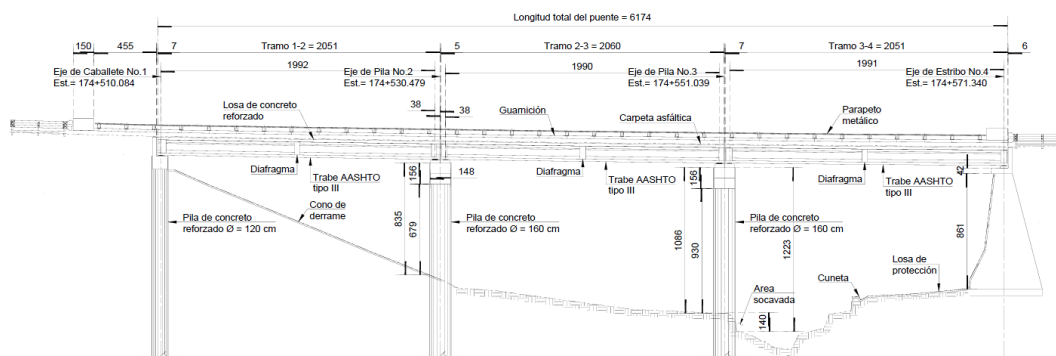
Elevación longitudinal del Puente bajo estudio
